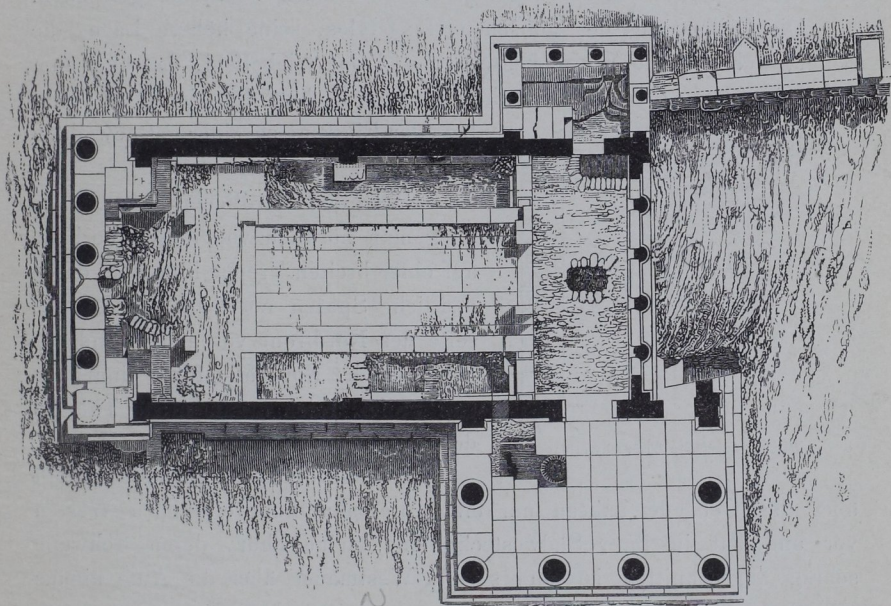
Erechtheion, Grundriss in heutiger Gestalt.
